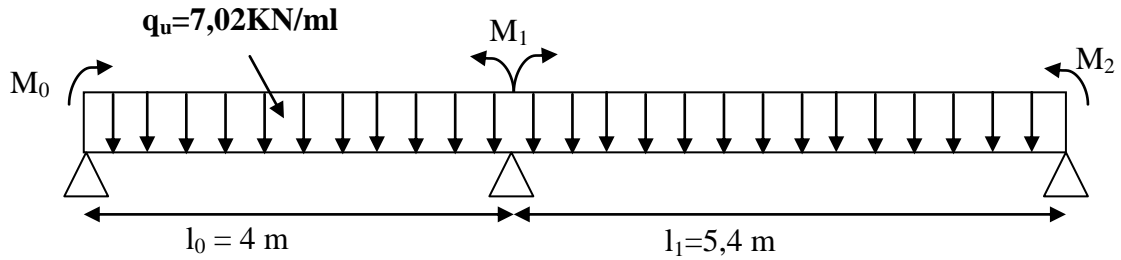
Schéma statique de la poutrelle à l'ELU
